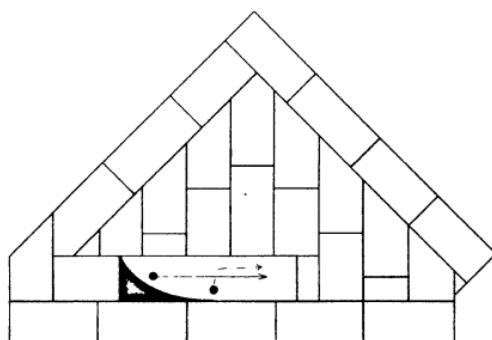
Кладка отопительной треугольной печи № 5 (продолжение)
